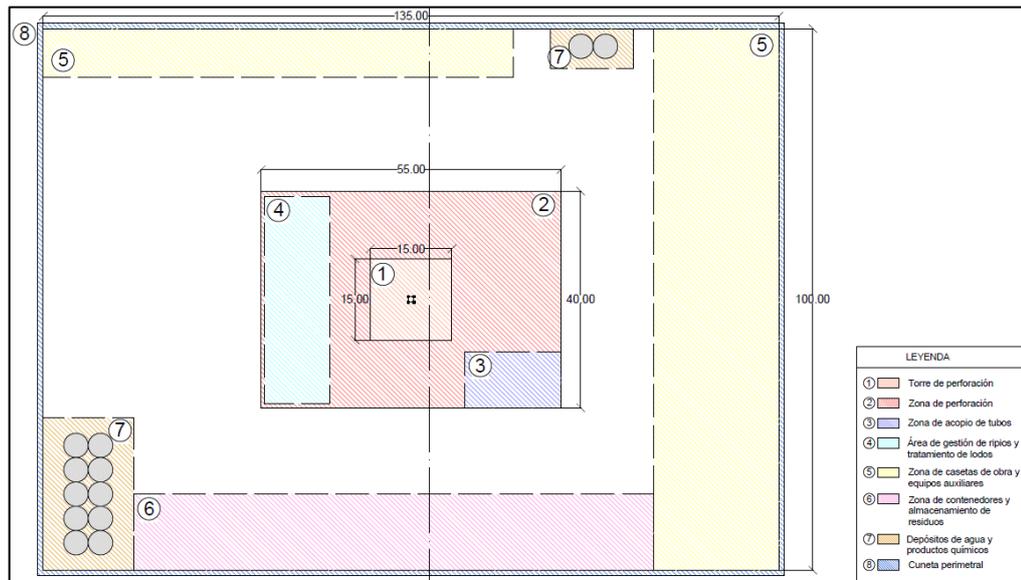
Planta del emplazamiento previsto del sondeo Monzón-2
